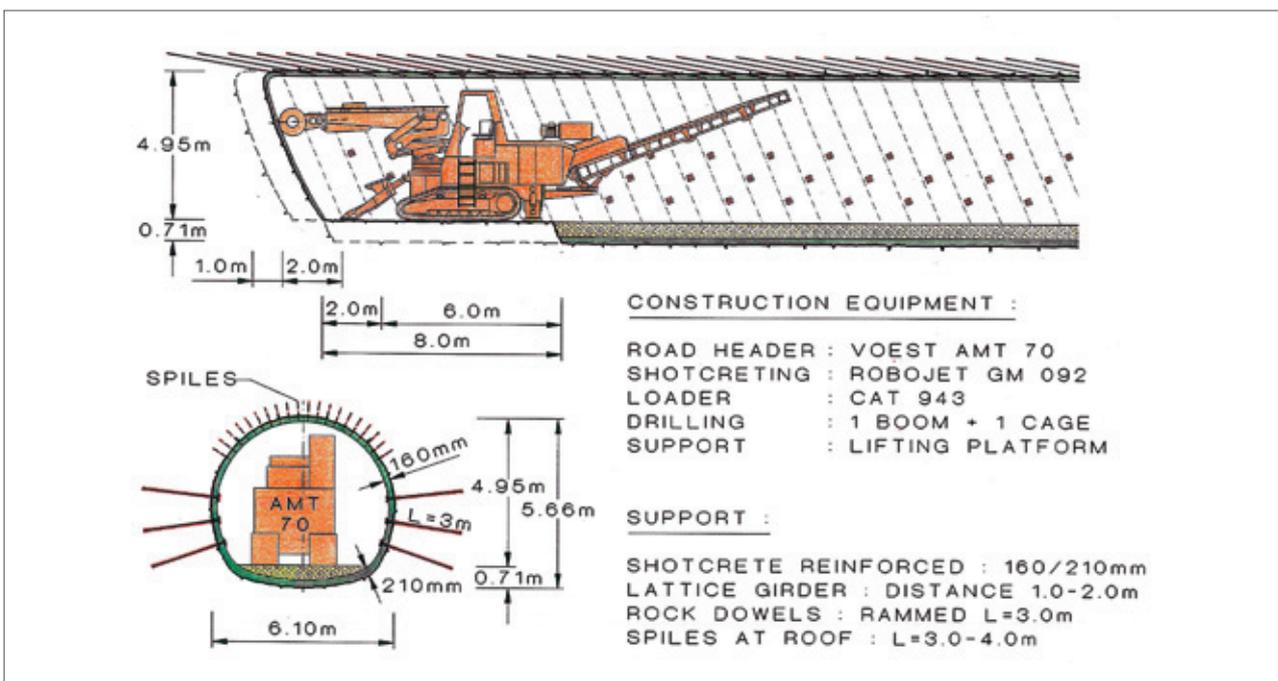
Castle Hill Tunnel, Vortriebsschema des Dienststollens
